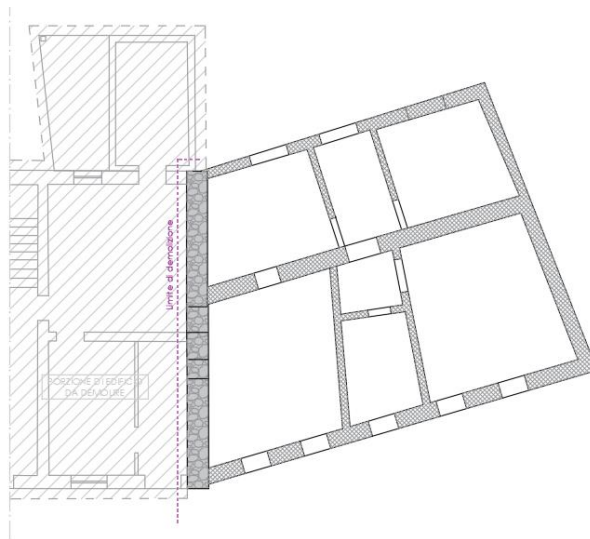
Individuazione porzione di edificio da demolire, muro di confine da consolidare ed edificio non oggetto di intervento
